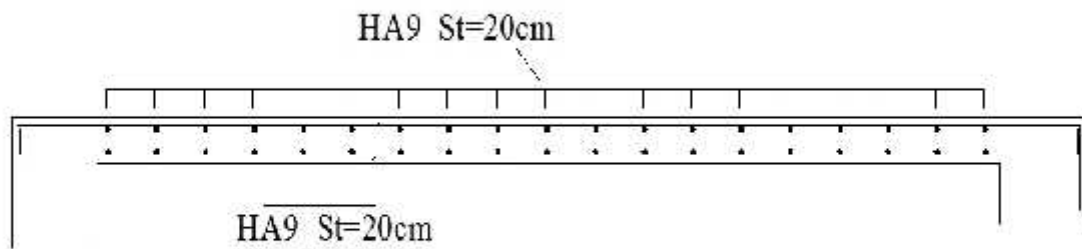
ferrailage de la dalle pleine dans le sens x-x
